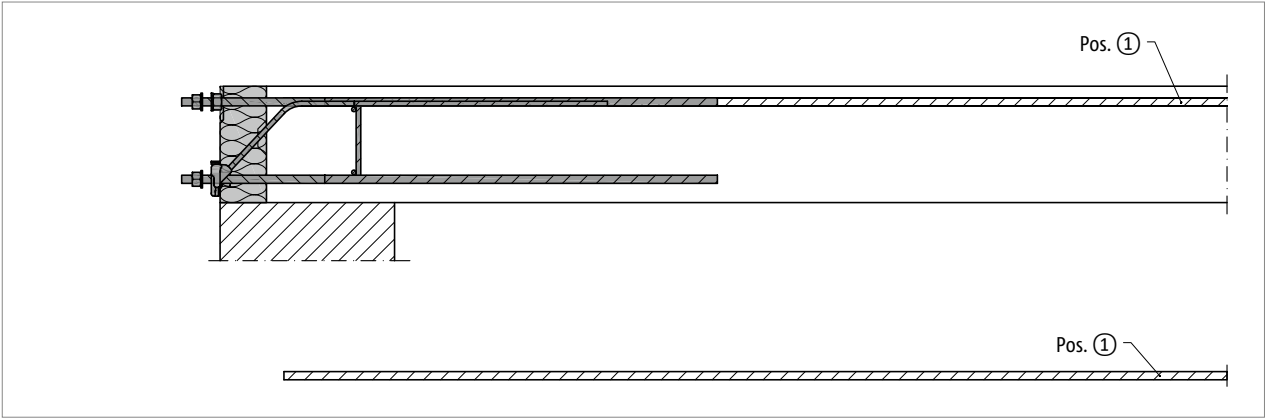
Schöck Isokorb® T Typ SKP-MM1-VV1: Bauseitige Bewehrung, Schnitt
